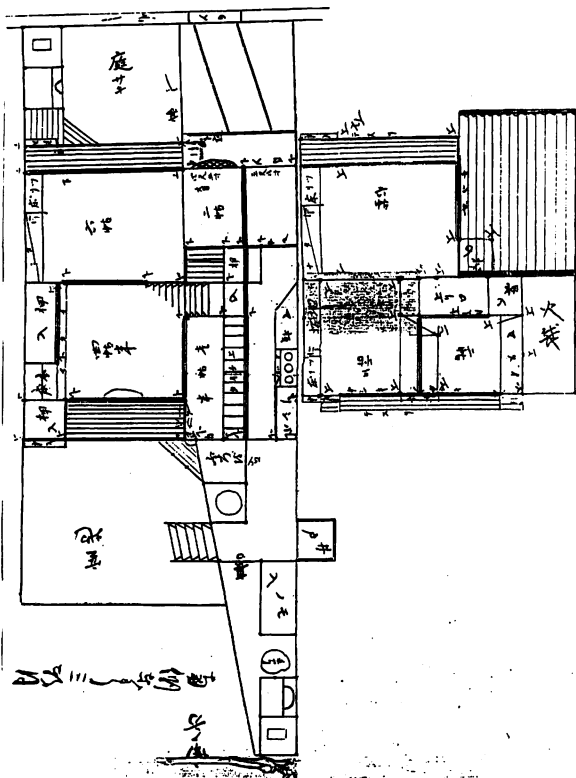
開発当初の家屋の平面図(25番)(上村家蔵)
